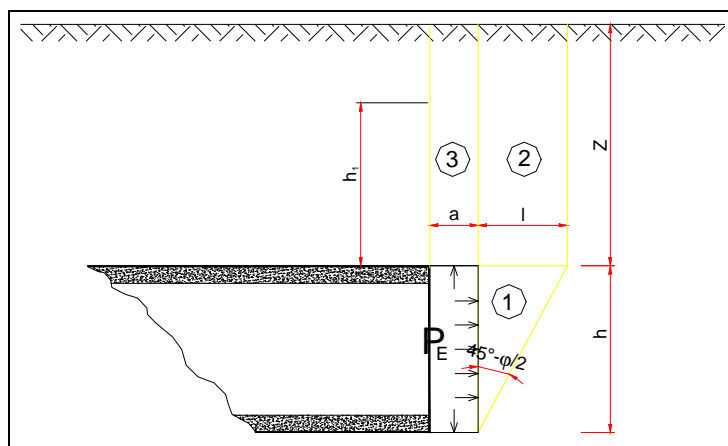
Sezione longitudinale dello schema proposto da Tamez
